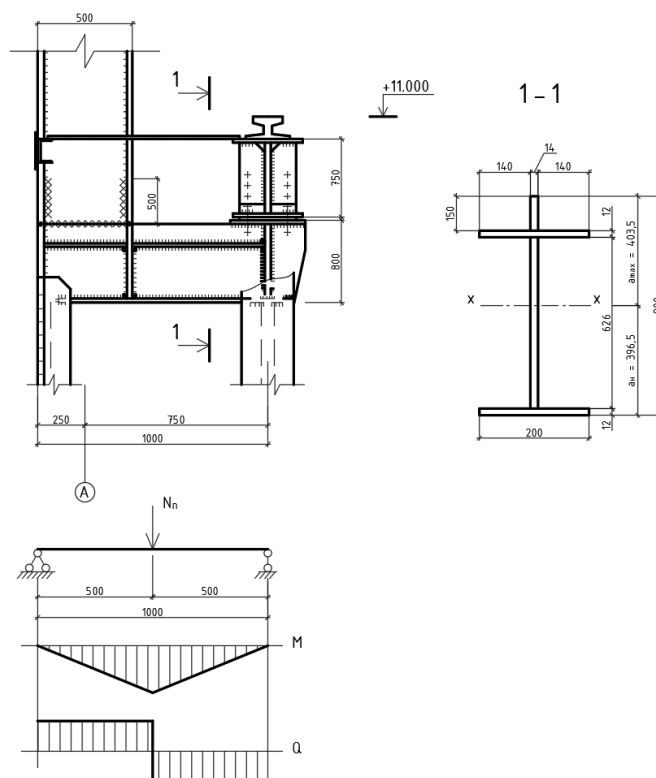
Конструкция и расчетная схема соединительной траверсы
